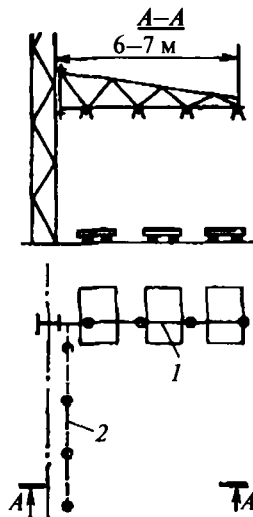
Поворотный кронштейн ОП для освещения зоны адьюстажа, расположенный вдоль колонн цеха: 1 — рабочее положение; 2 — положение при транспортировке заготовок крапом
